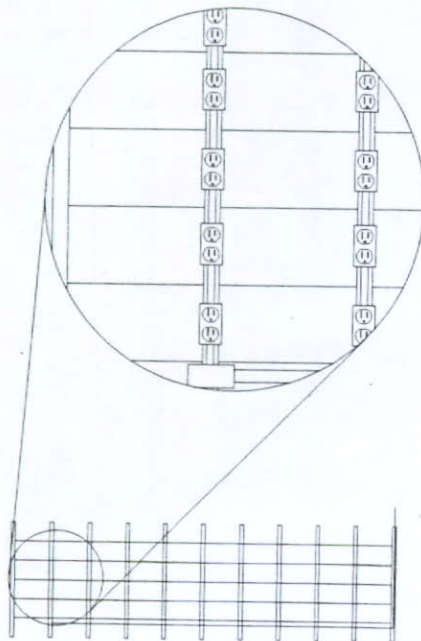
Instalación de tubería conduit en las celdas de runin/download.
